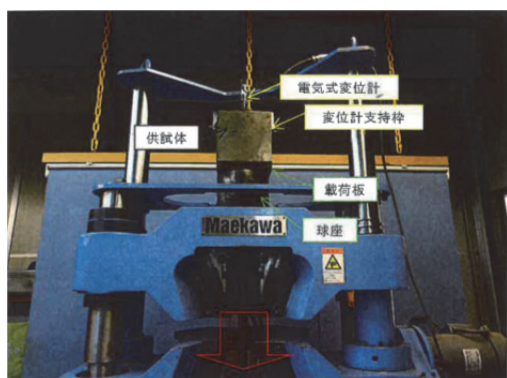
鉄筋とコンクリートとの付着強度試験実施状況
